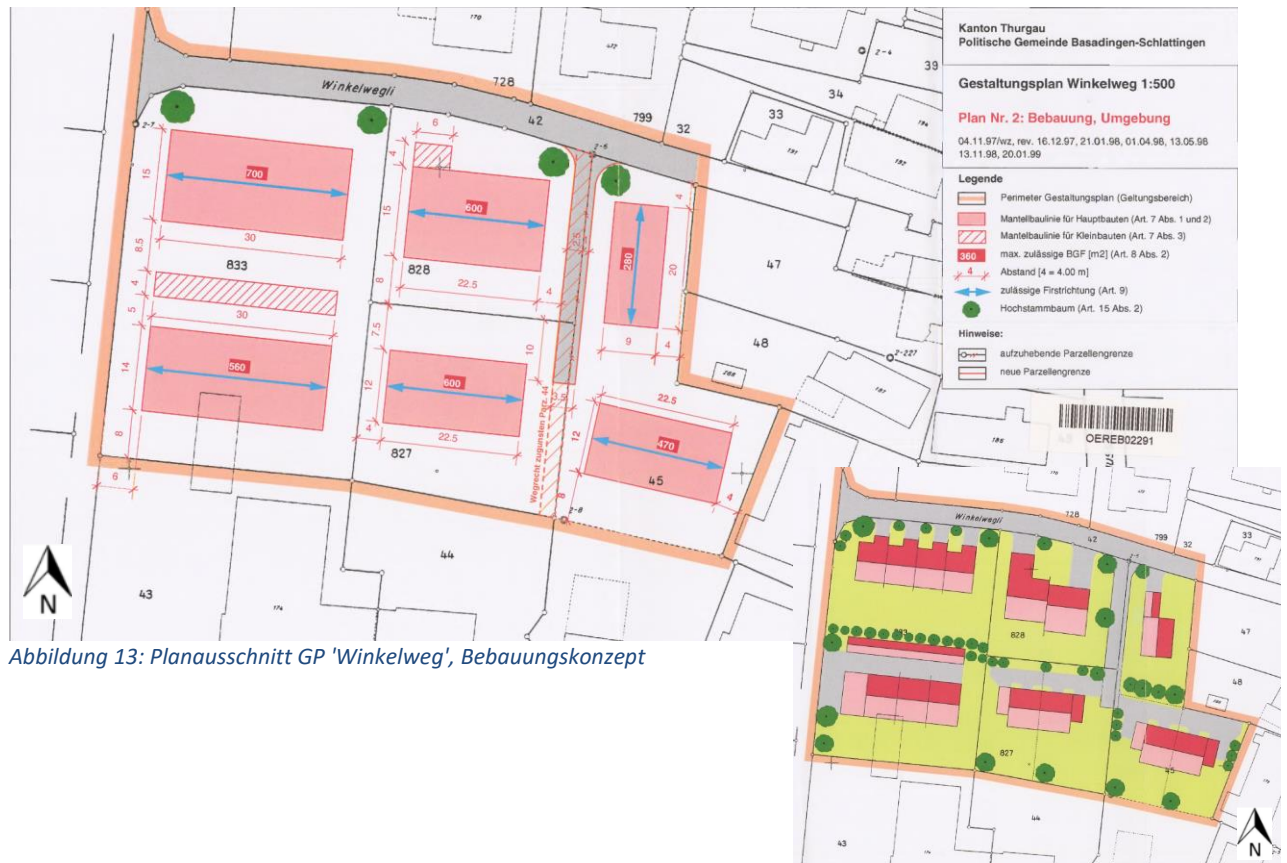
Planausschnitt GP 'Winkelweg', Bauungskonzept
